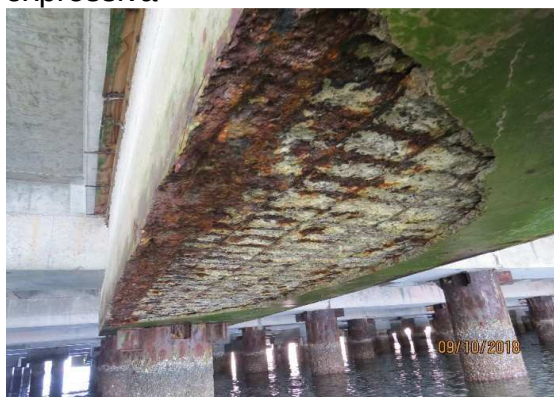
PORÇÃO INFERIOR. Notar bloco de coroamento do Sistema B com armadura exposta e já em corrosão
